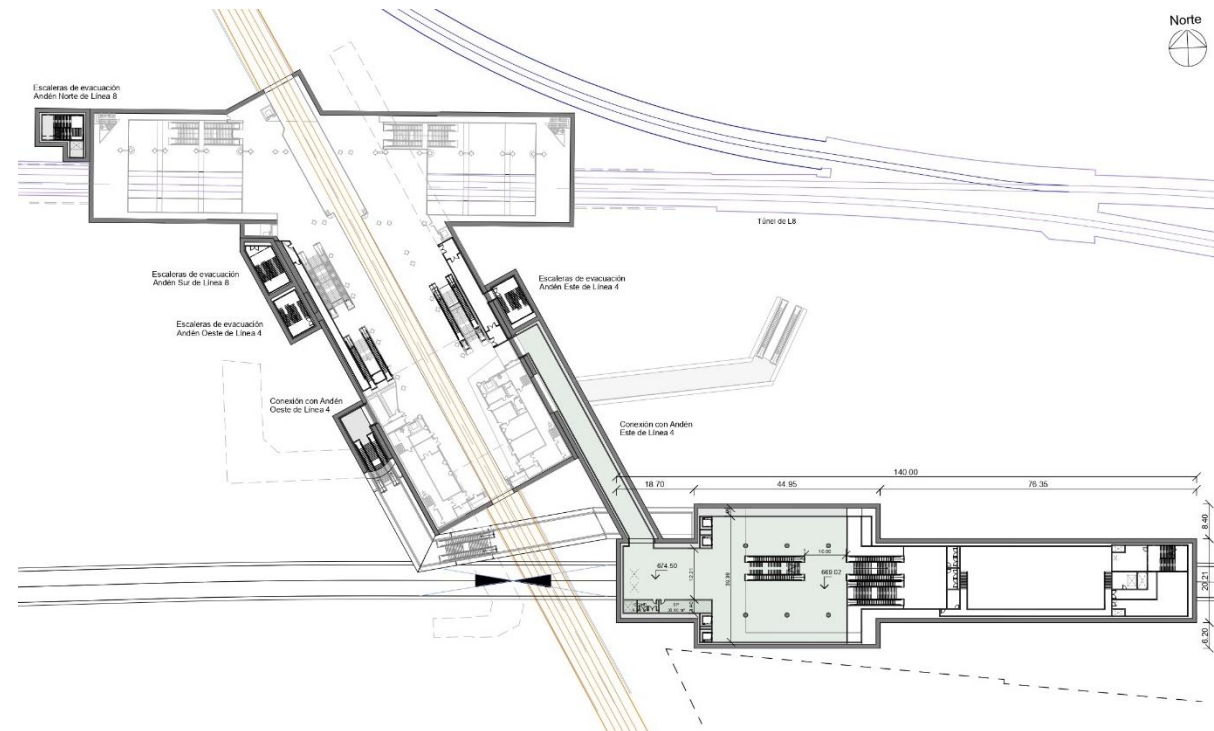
Estación Mar de Cristal – Calle Arequipa _Planta conexión con L4
